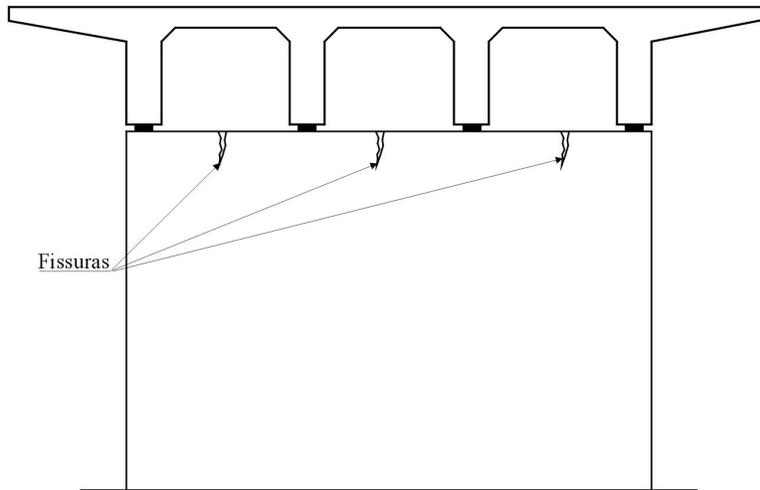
Fissuras verticais em pilar-parede
